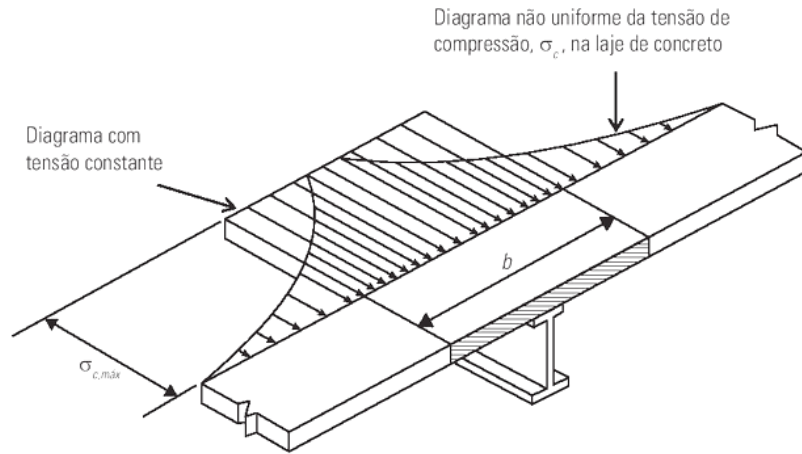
Largura efetiva de laje de concreto (FAKURY, 2016)
